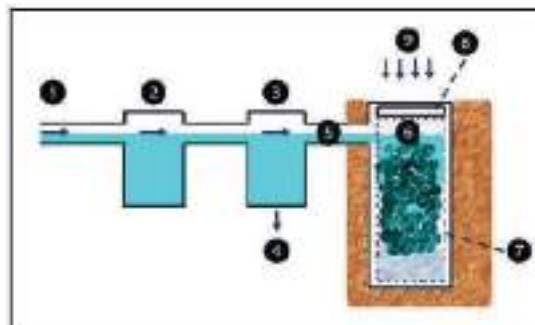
Elementos principales de un pozo de absorción. (1) Alimentación, (2) Decantador, (3) Cámara vertedora (opcional), (4) Rebase o vertedor, (5) Tubería de conexión, (6) Pozo, (7) Geotextil, (8) Cubierta, (9) Alimentación superficial (opcional)
